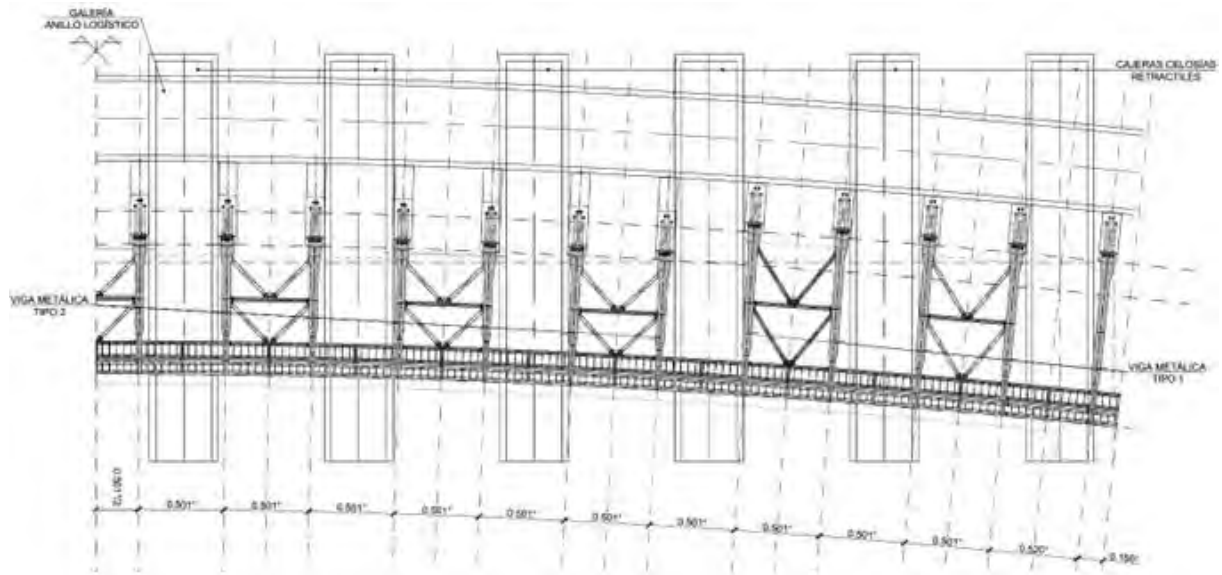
Plano de planta de disposición de elementos estructurales de grada.
